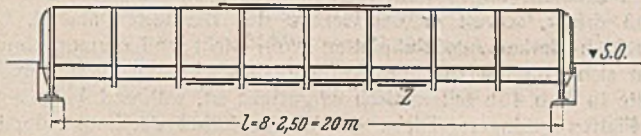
„Echte Trogbücke“ mit durchgehender Bettung, Ansicht.
